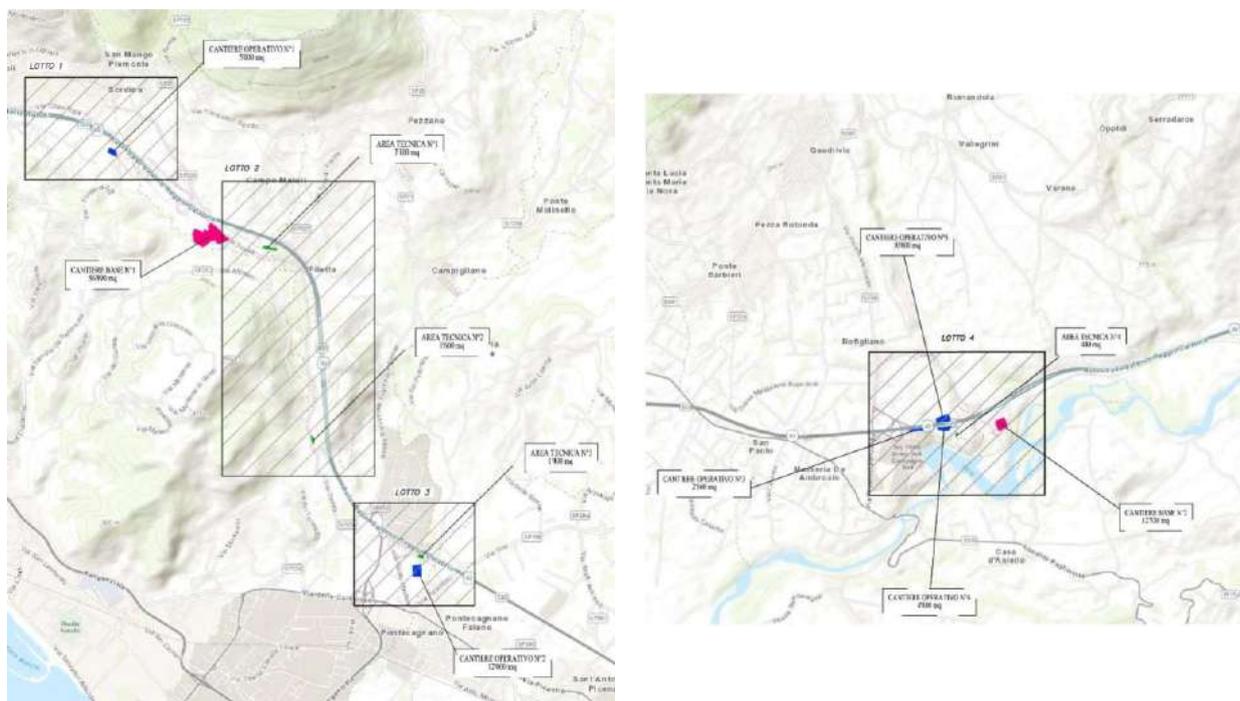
Estratto planimetrico con individuazione dei cantieri base, operativi e aree tecniche.
